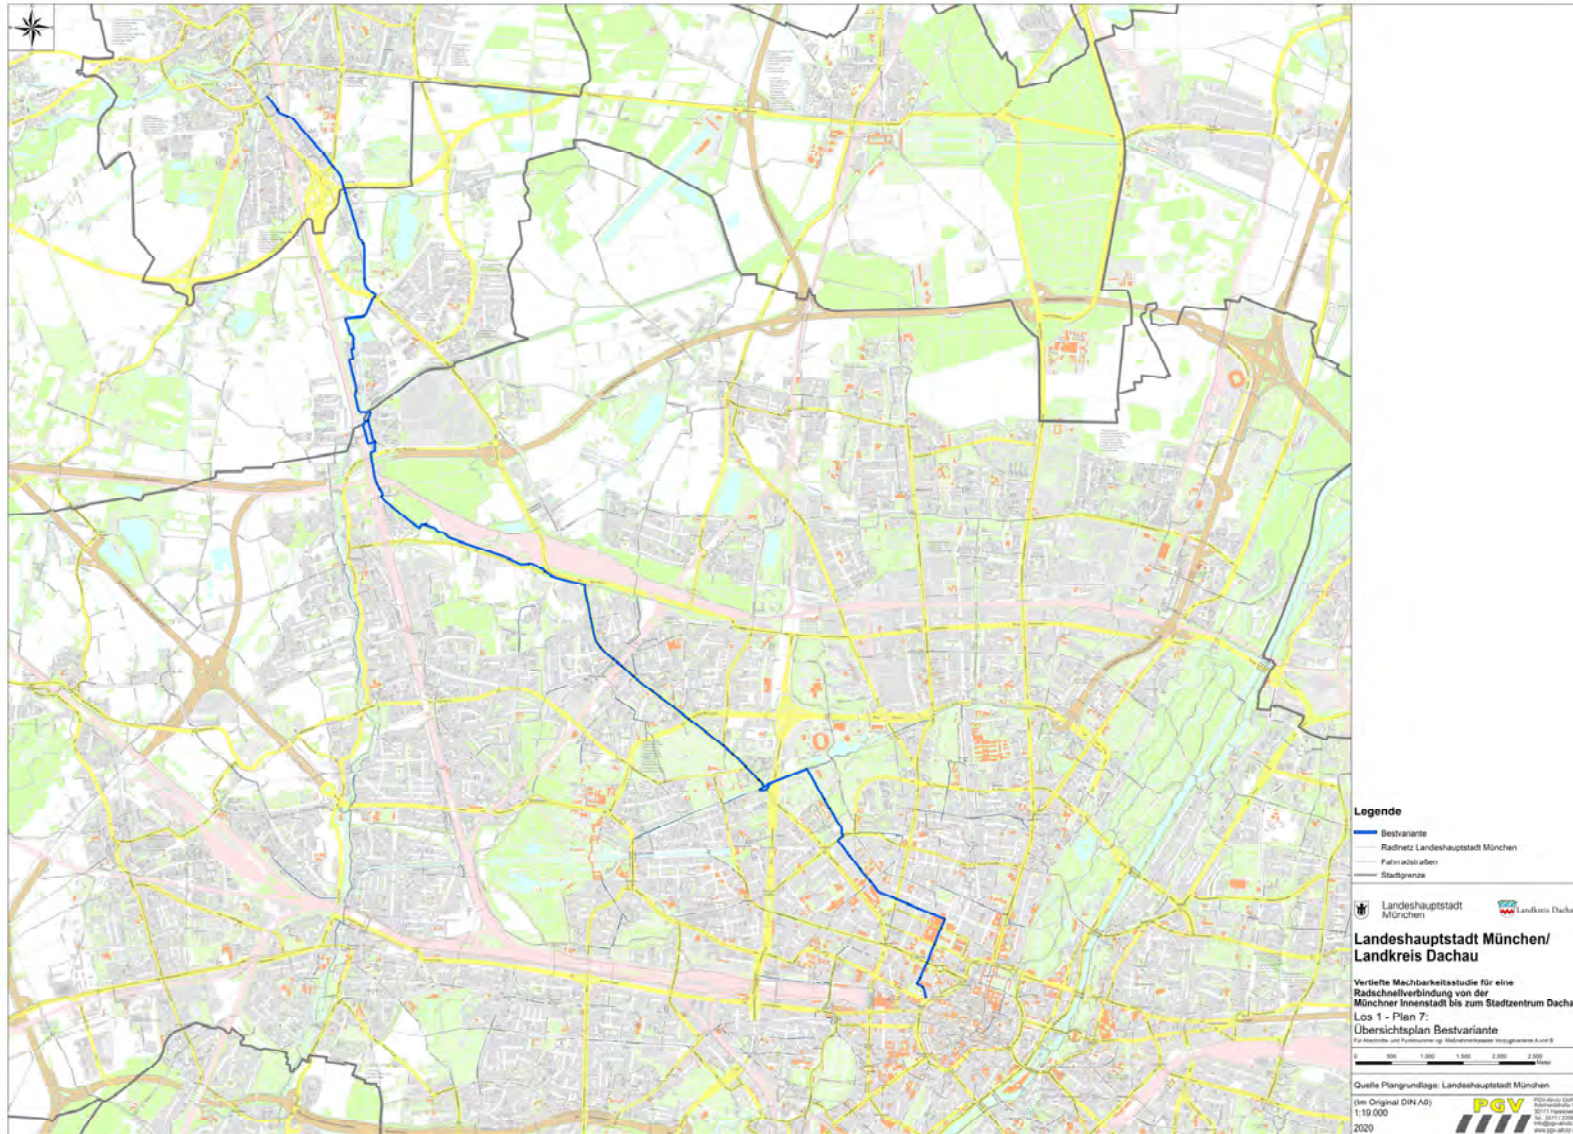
Verlauf der Bestvariante (Plangrundlage: Landeshauptstadt München, Darstellung: PGV-Alrutz GbR)
